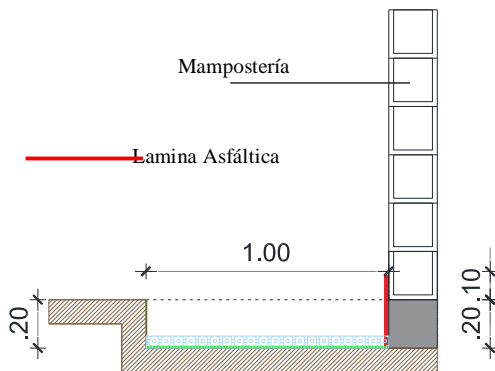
Detalle de Colocación Lámina Asfáltica Súper K en Cadena (S/E)
